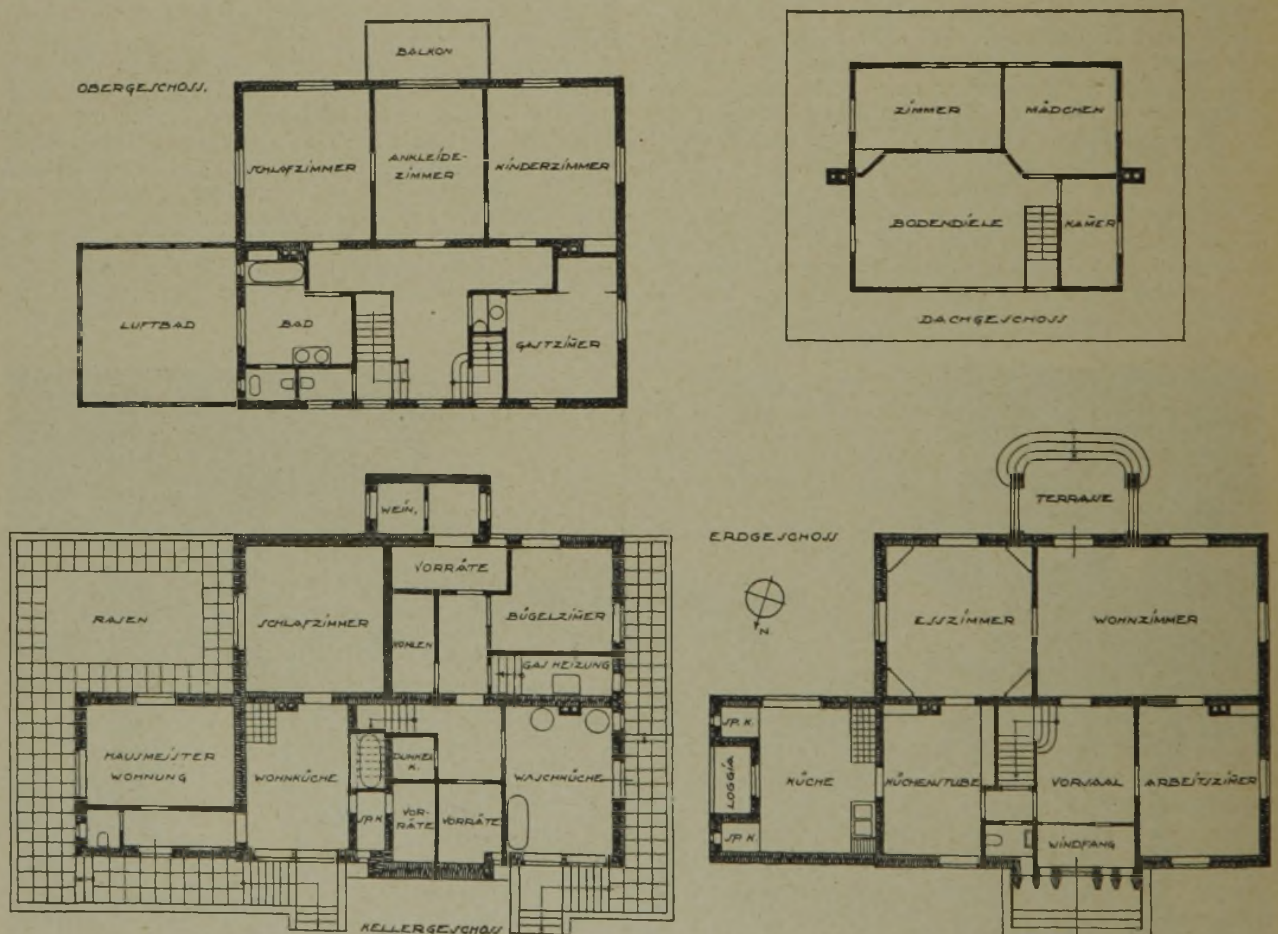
6. Grundrisse vom Haus Tiergartenstraße 74 in Dresden. (1 : 250.)
